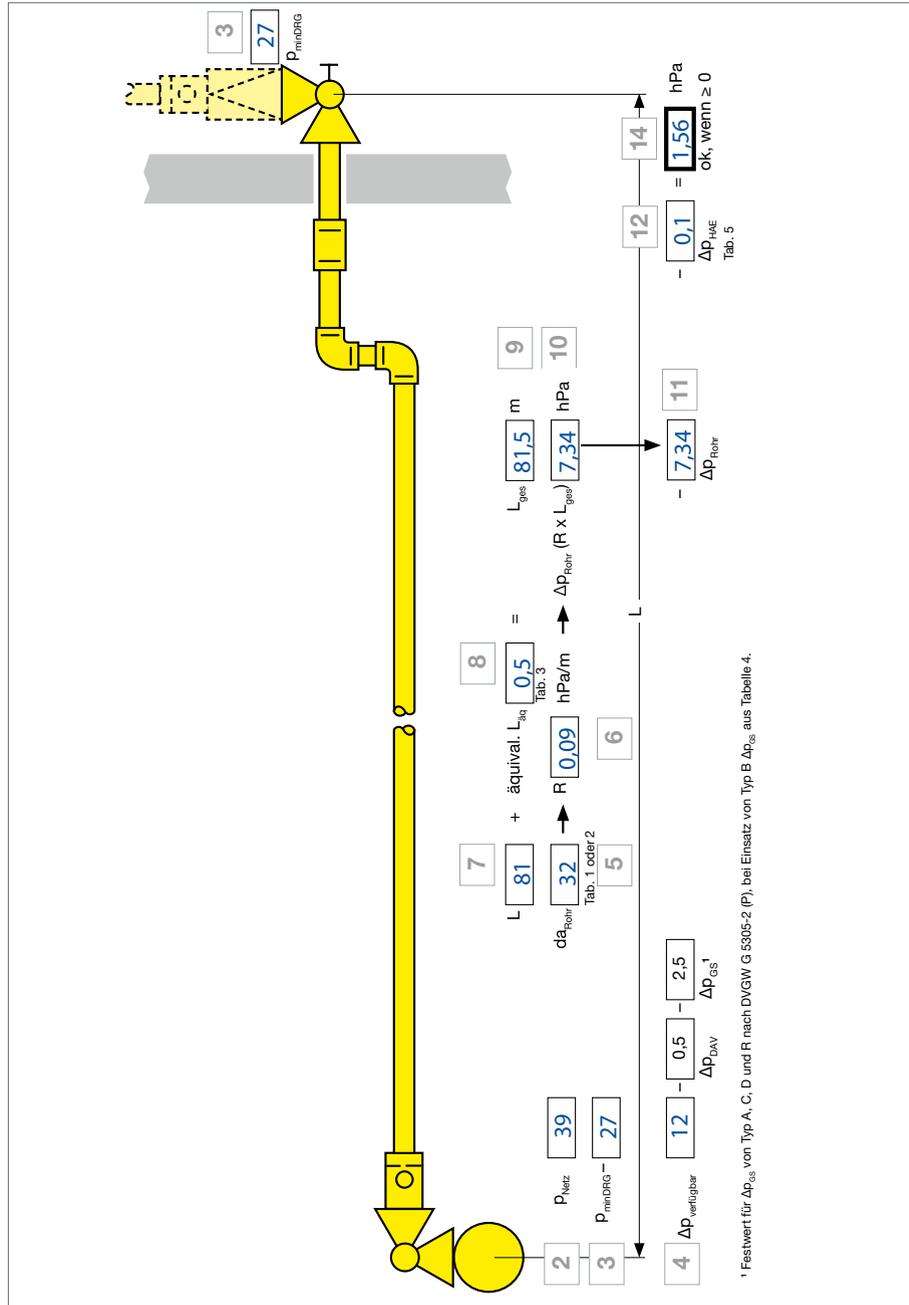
Beispiel 2 – Formblatt 2, oberer Teil
